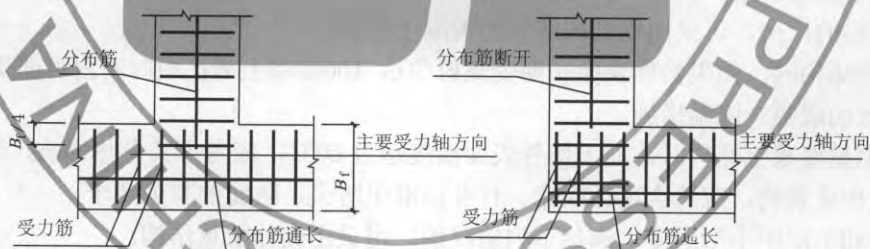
钢筋混凝土条形基础拐角、T 字配筋
